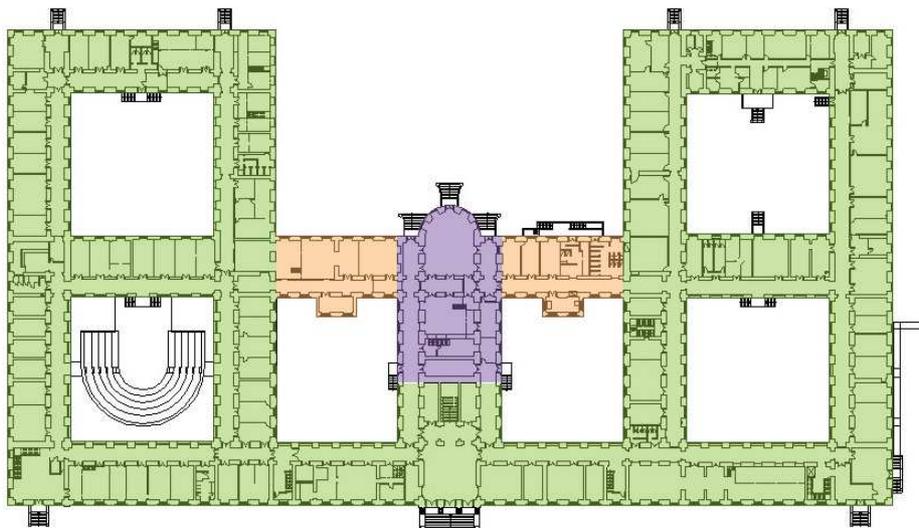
Planta, indicando área com um pavimento em marrom, dois em verde e três em roxo.
